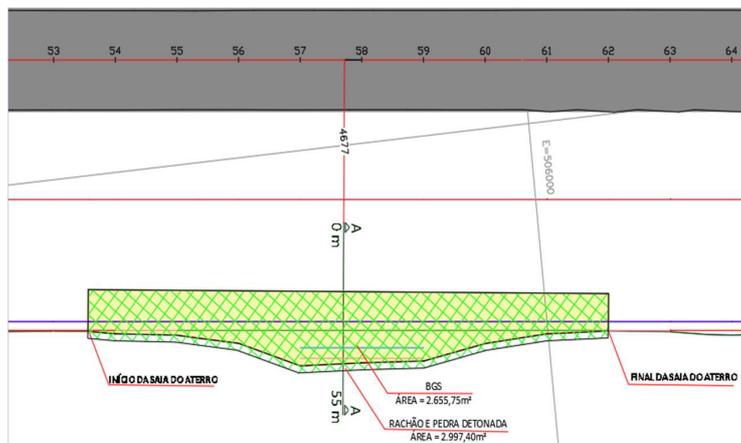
Planta do aterro compactado entre as Estacas 53 + 11m e 62
